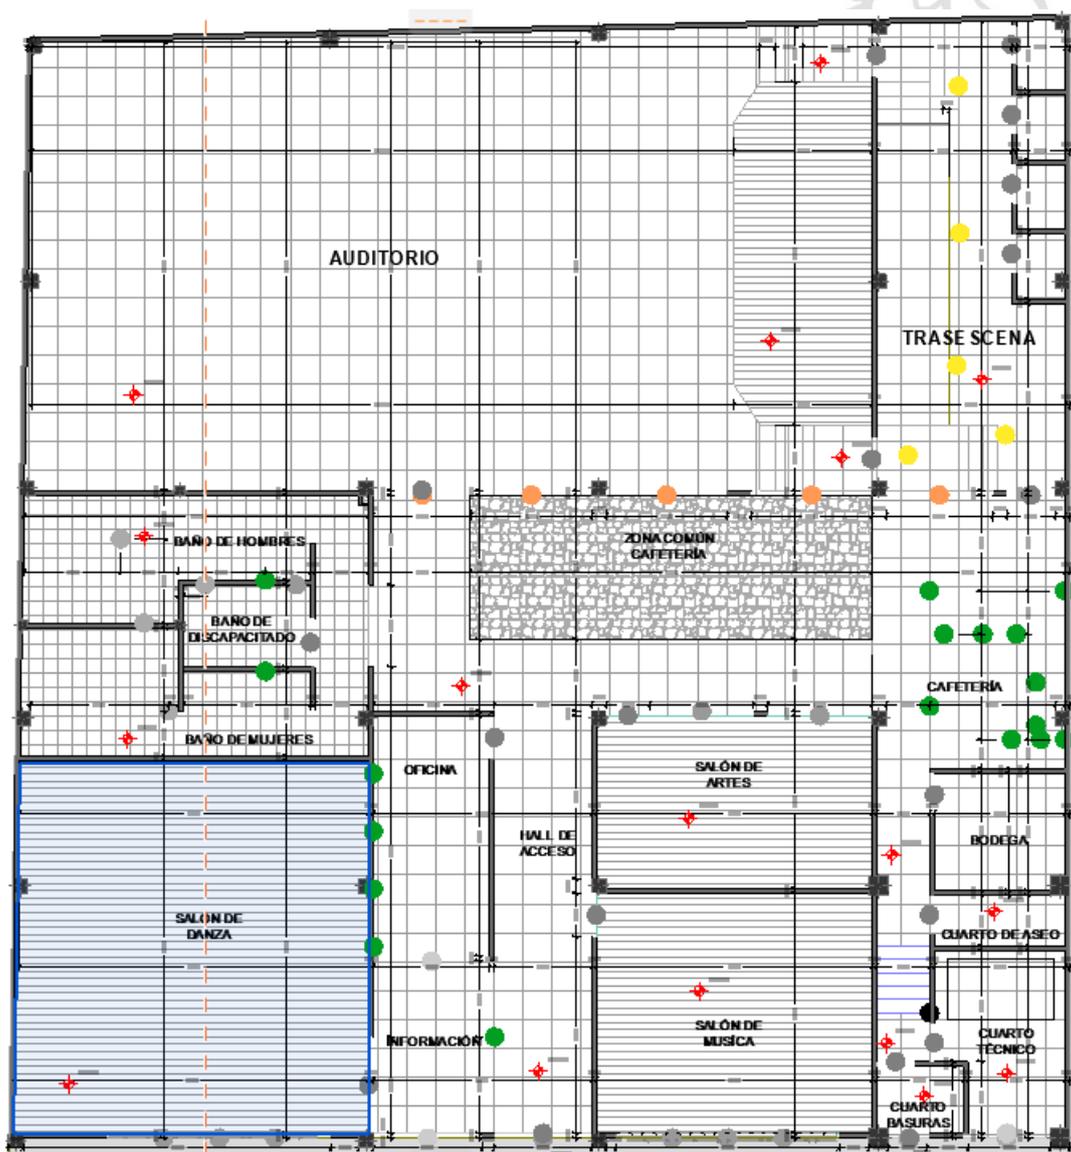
Planta arquitectónica del proyecto. Fuente: UT Casa de la Cultura
